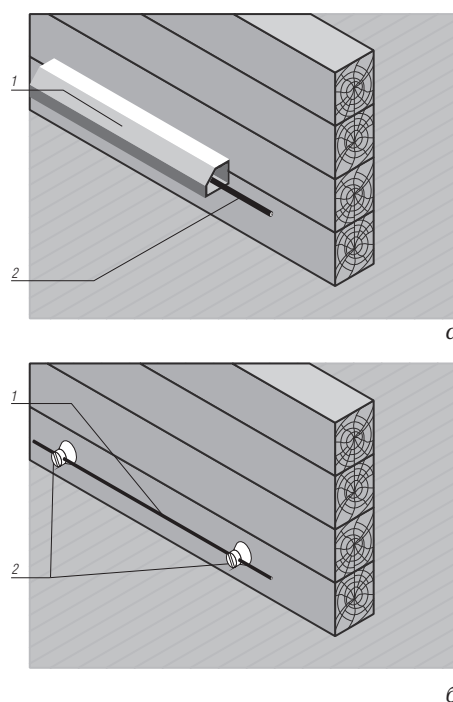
Прокладка кабеля в доме с деревянными стенами: а — открытая проводка в кабель-канале: 1 — кабель-канал; 2 — кабель; б — скрытая проводка на роликах: 1 — кабель; 2 — ролики
